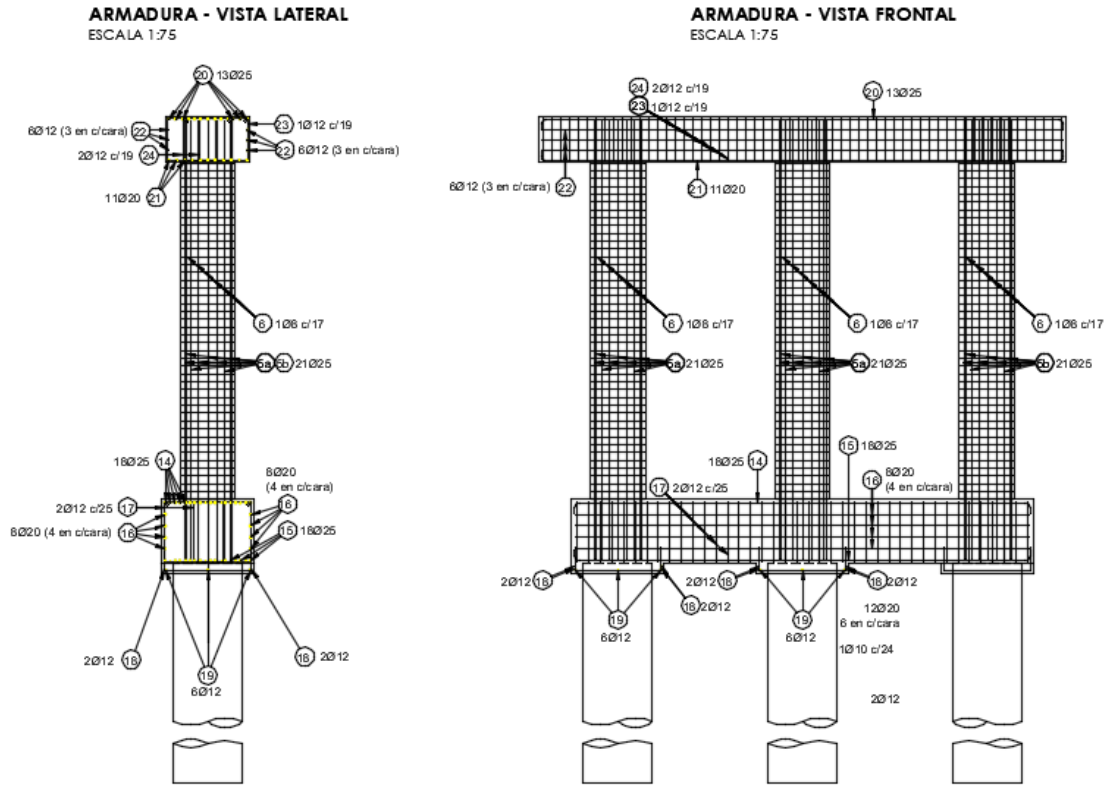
Armaduras en Pilas del Puente típico de la clase VH-SATM.
